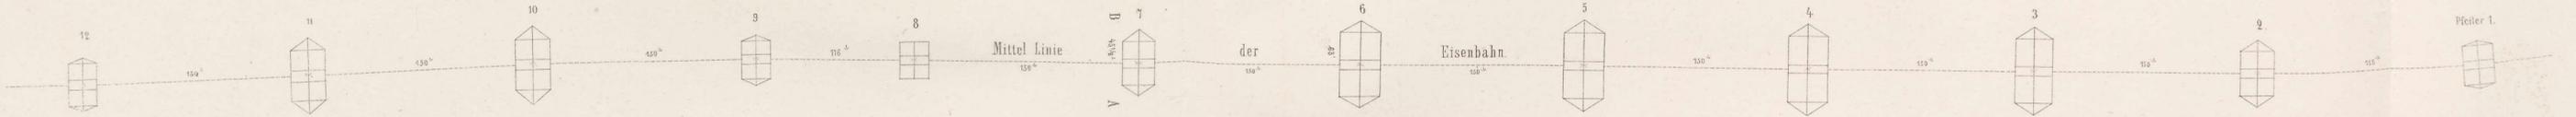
Grundriss der Brückenträger nach C.D.
